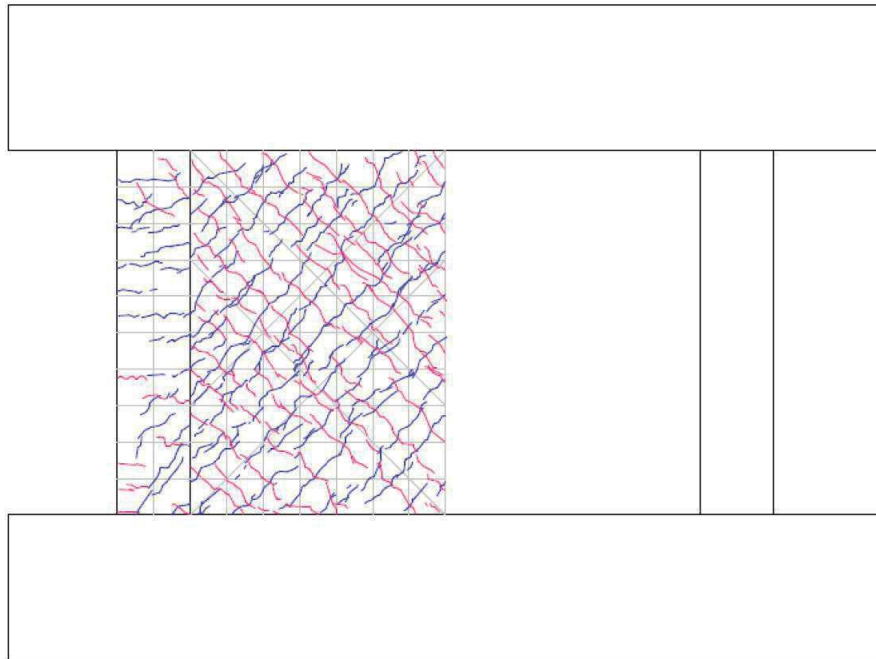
試験体 S-13-DIII 事前加力終了時 (4/1000rad.) ひび割れ図
